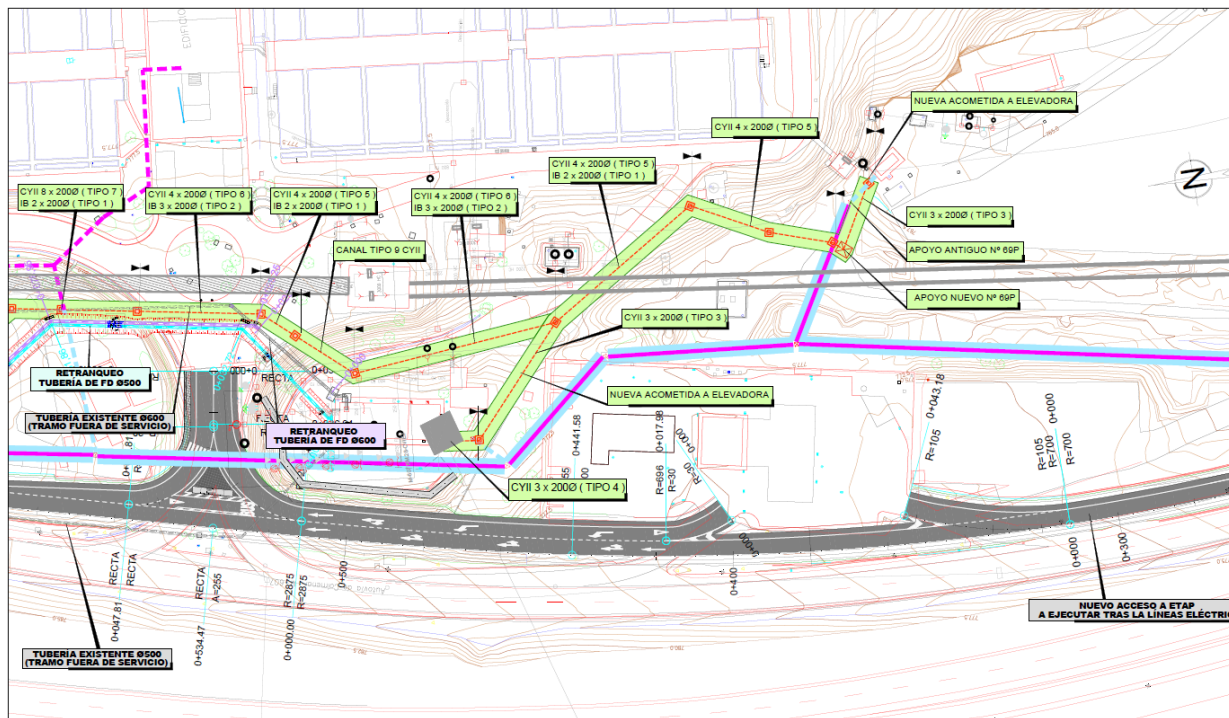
Trazado de zanjas y líneas aéreas de alta tensión previstas en el proyecto acondicionamiento del vial de acceso a la ETAP
